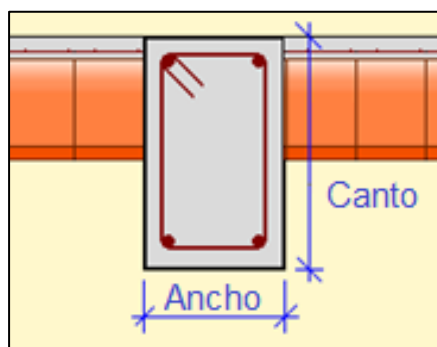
Esquema viga descolgada rectangular. Fuente: Cypecad 2015.
